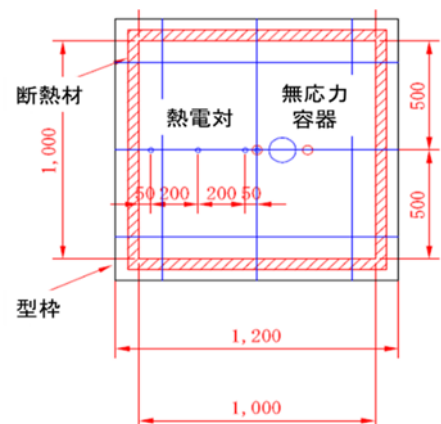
立方体試験体・平面図（砂防ダム、橋脚）
